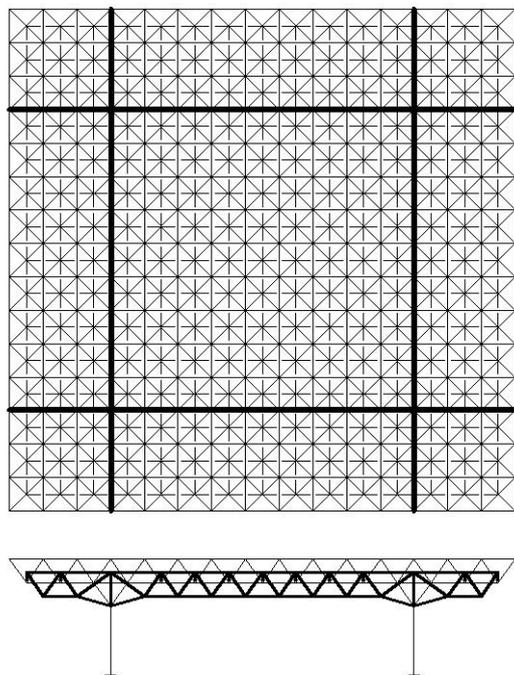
Усиление структурной конструкции путем подведения дополнительных опор на примере усиления покрытия здания Мерседес-Бенц Сервис, г. Казань
